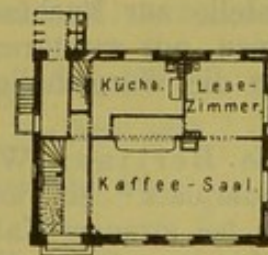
Volkskaffeeschenke in Bremen. Grundriß. Erdgeschoss.
